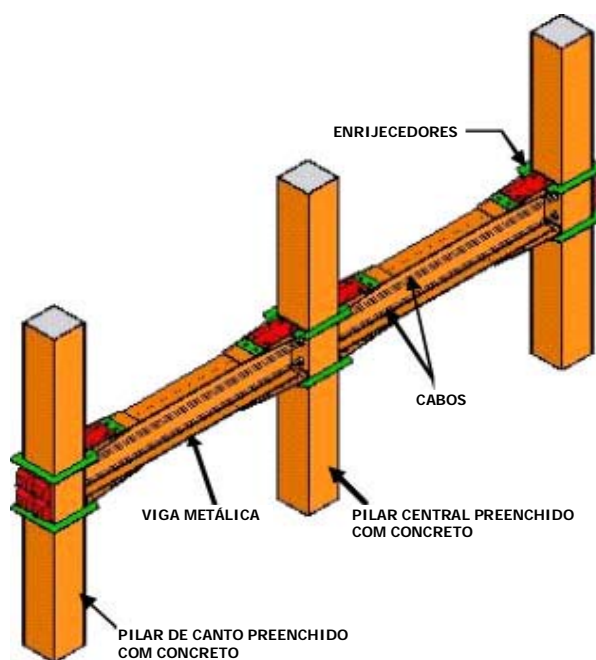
Ligação protendida entre pilar preenchido e viga metálica (CHOU *et al.*, 2006).
